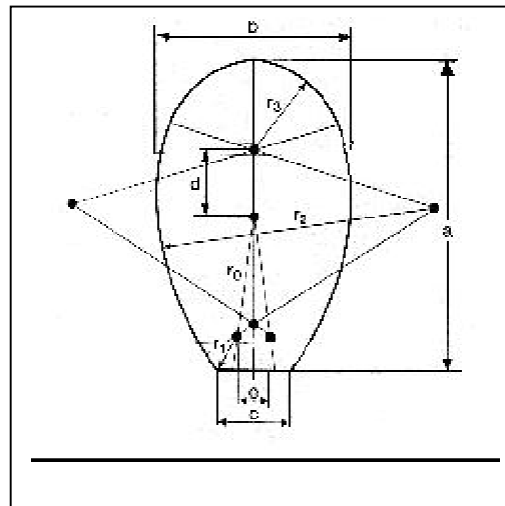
Coupe type d'un tuyau ovoïde préfabriqué
